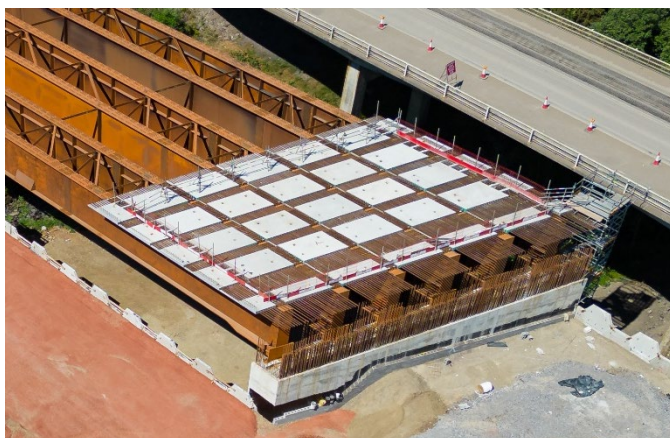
Montaje de placas en los extremos del vano con uniones in situ y riostra de estribo pendiente de ejecutar.
